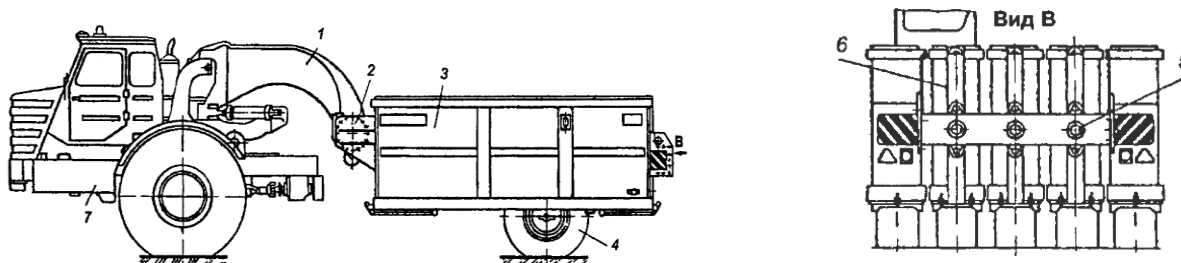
Полуприцепной пневмоколесный каток ДУ-16 Г: 1 – дышло; 2 – рама; 3 – бункер для загрузки балласта; 4 – пневмоколесо; 5 – механизм стопорения секций; 6 – секции катка; 7 – тягач МОАЗ
